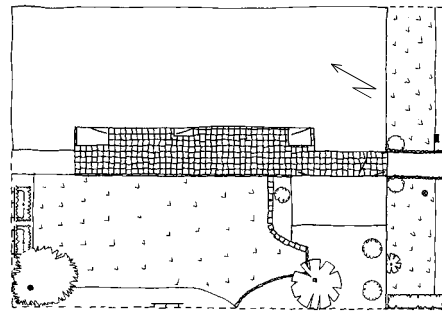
Planritning, Riggatan 8. Skala 1:100.
